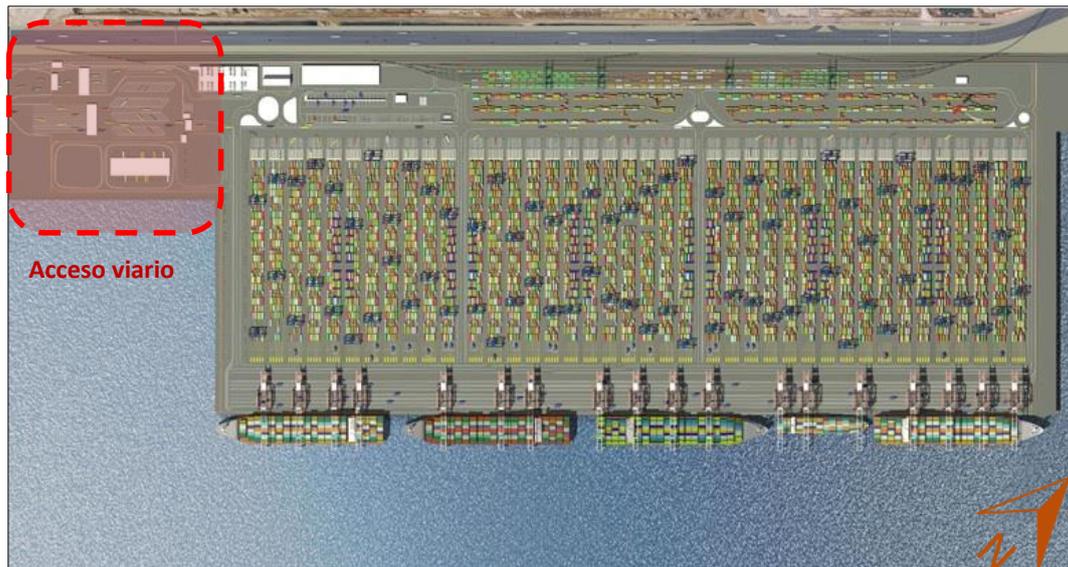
Vista en planta de la Terminal BEST y localización de su acceso viario
